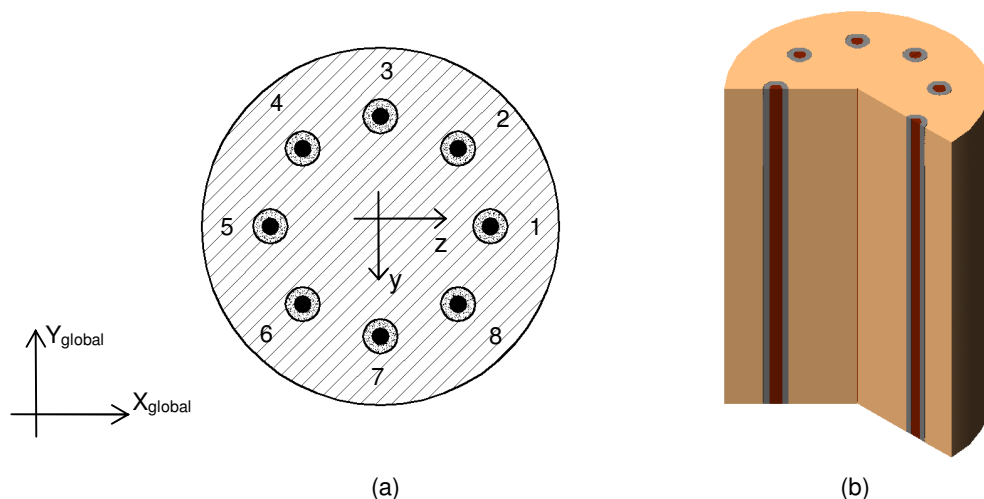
Solução 2 - Reforço da secção transversal dos pilares com armadura ordinária (8Ø32): (a) secção transversal; (b) segmento do fuste em corte/perspectiva.
